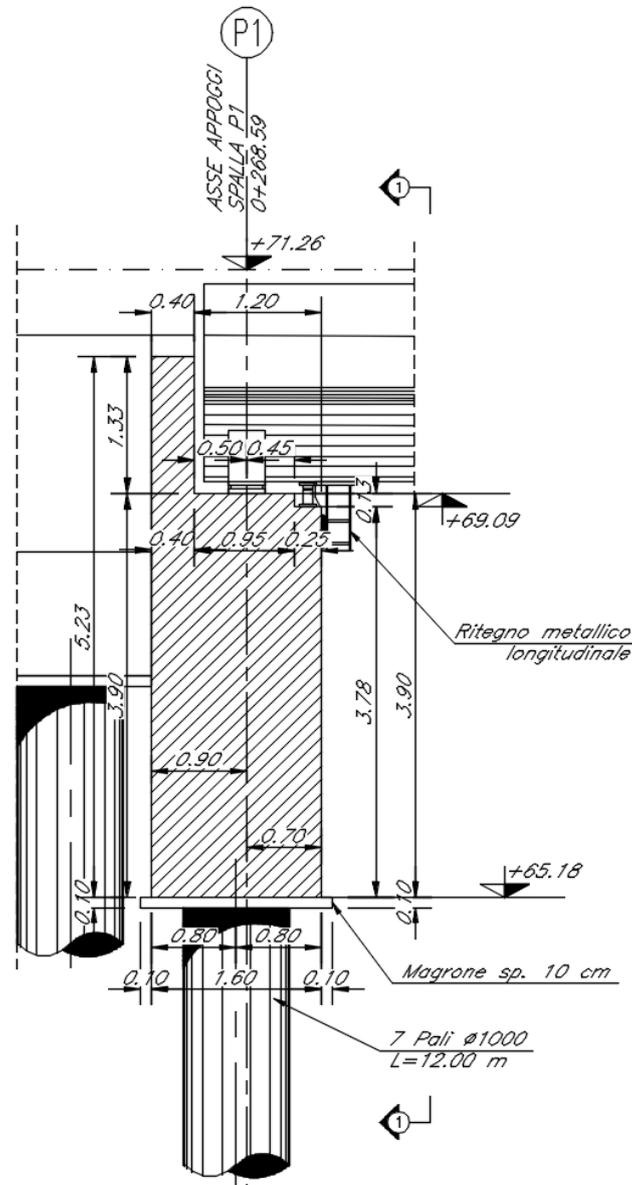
Spalla P1 - Sezione longitudinale 4-4 (sezione longitudinale altezza minore)
